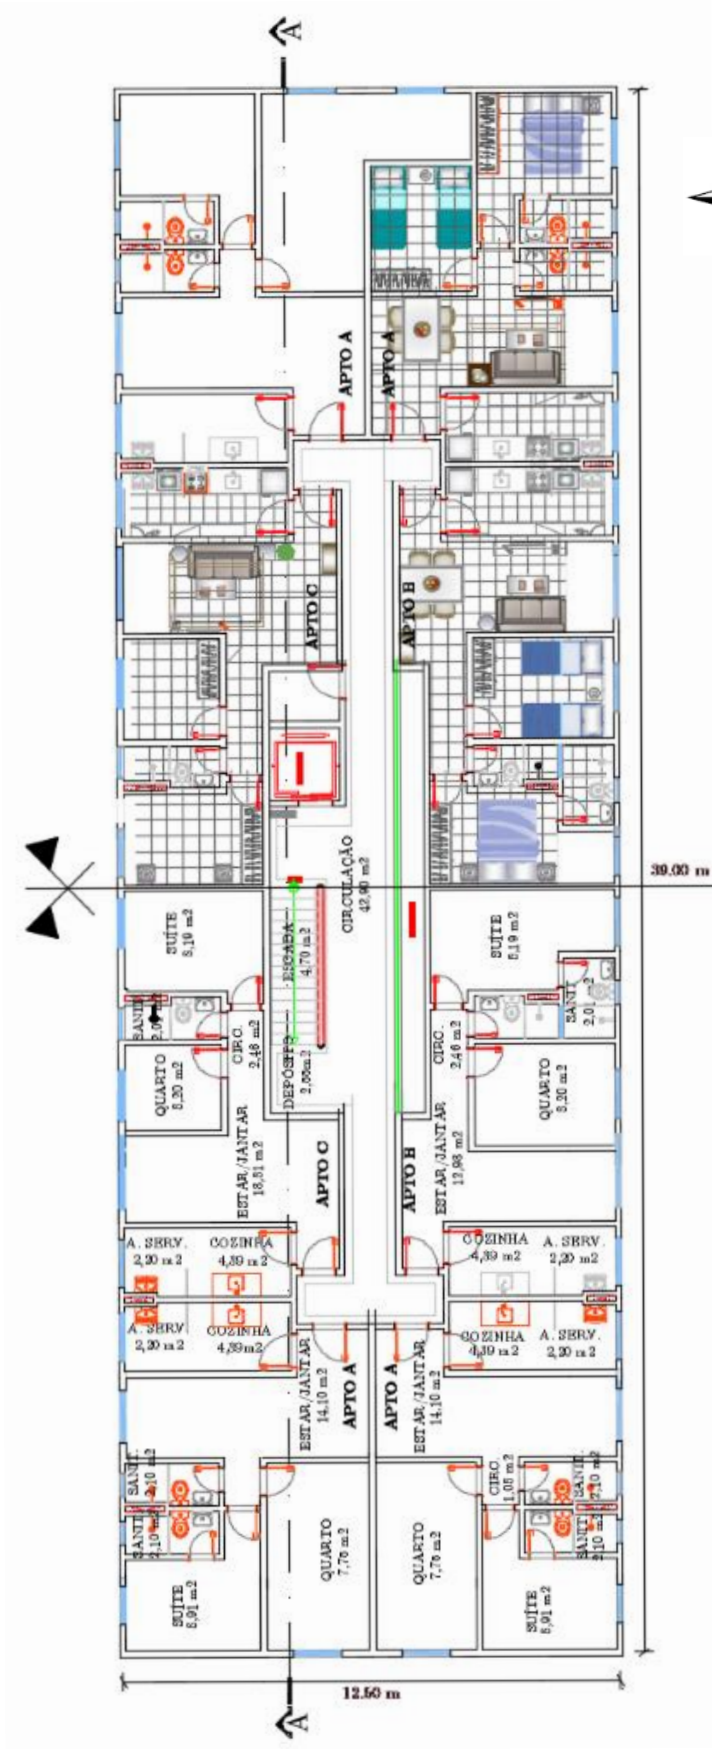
Planta de arquitetura do piso tipo do edifício.
